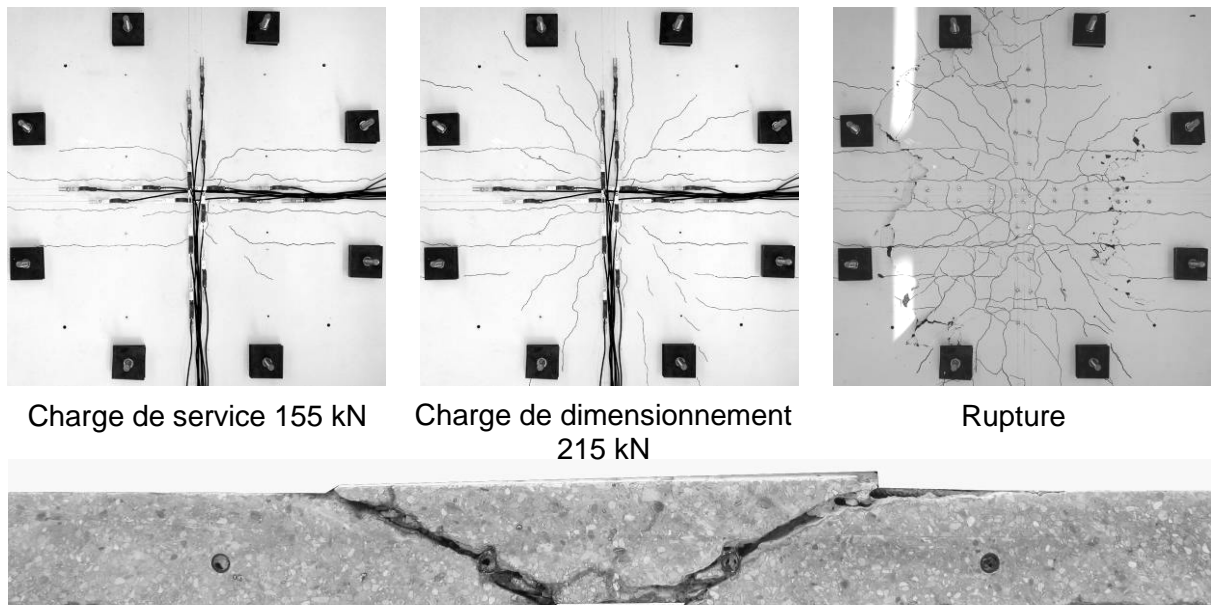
Fissuration à plusieurs niveaux de charge et fissures internes de la dalle B1-03.
